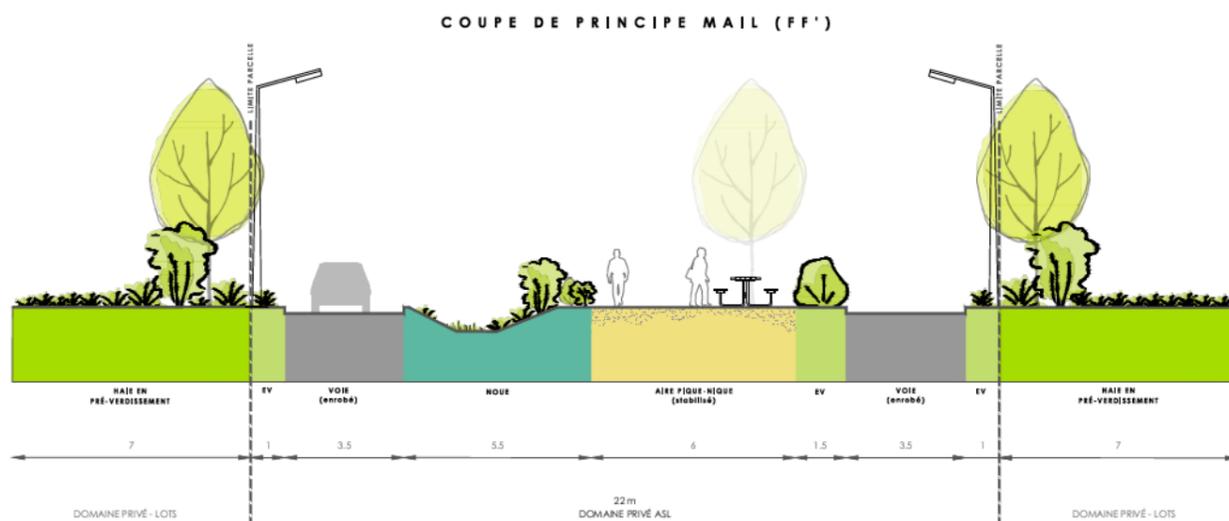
MAIL PAYSAGER - COUPE FF'
